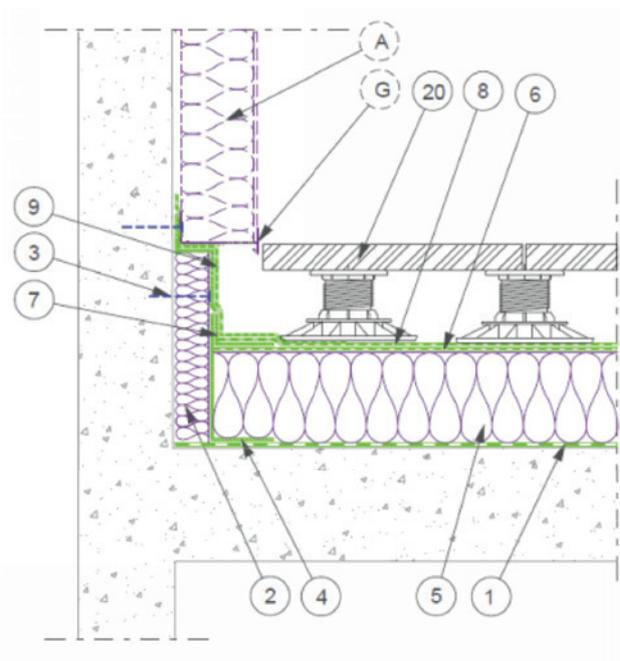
Relevé d'étanchéité sur isolant apte à recevoir un revêtement d'étanchéité bitumineuse soudé – pied de façade isolée par l'extérieur
